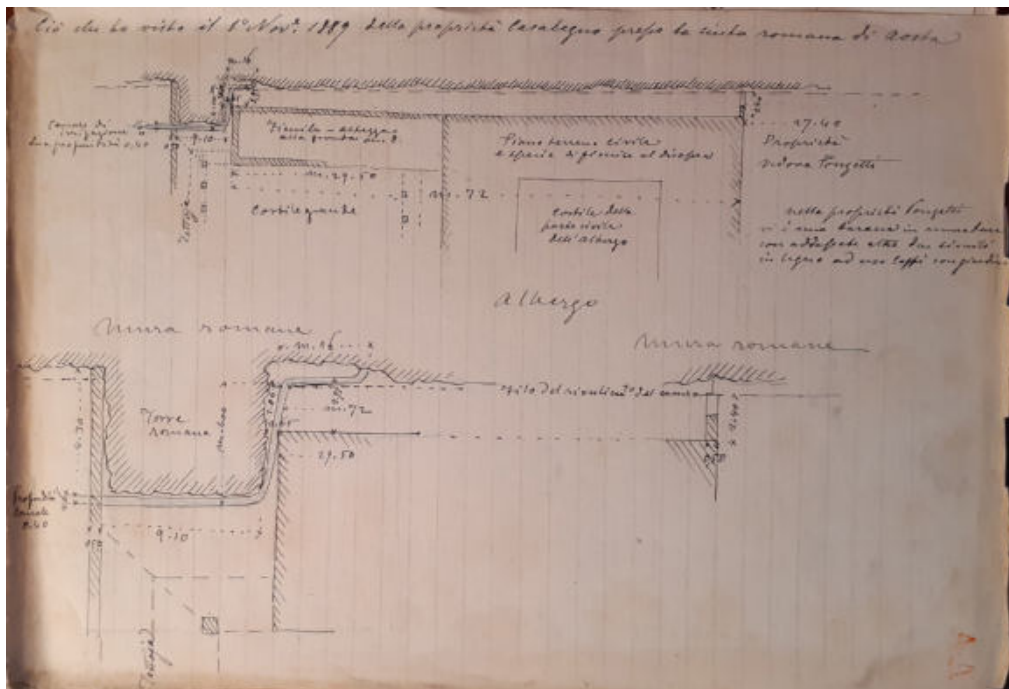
Rilievo di D'Andrade delle proprietà Casalegno e Pognetti (ASTO, Fondo D'Andrade, busta 67, 1892)
